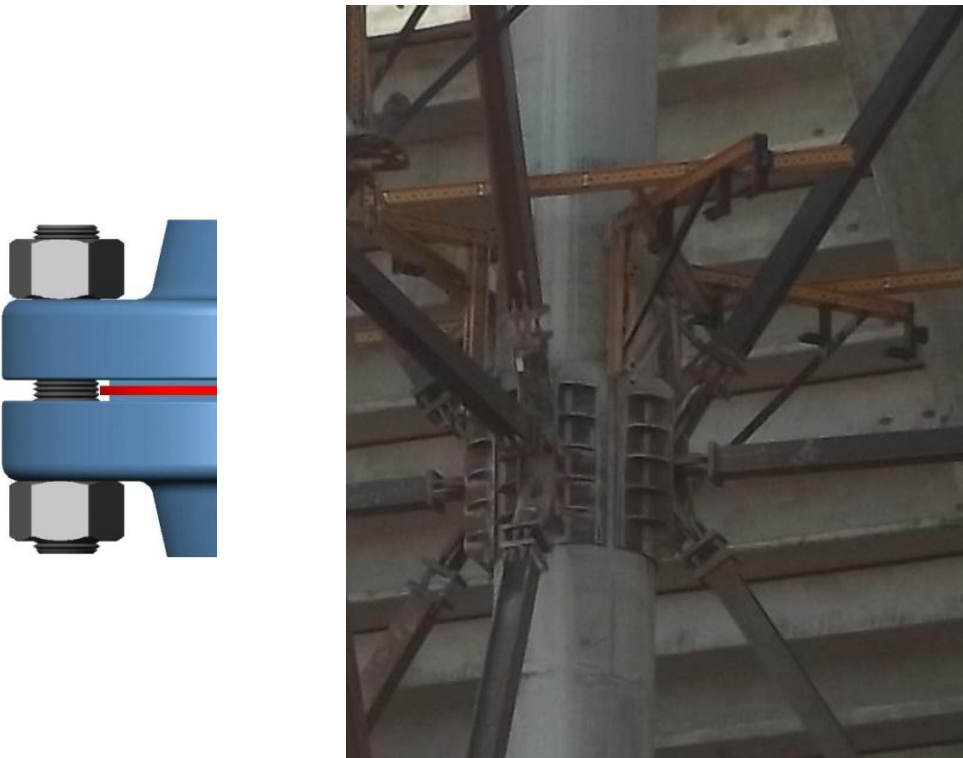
Conexões entre ligações concreto-aço utilizadas no estádio Mané Garrincha sito em Brasília/DF
